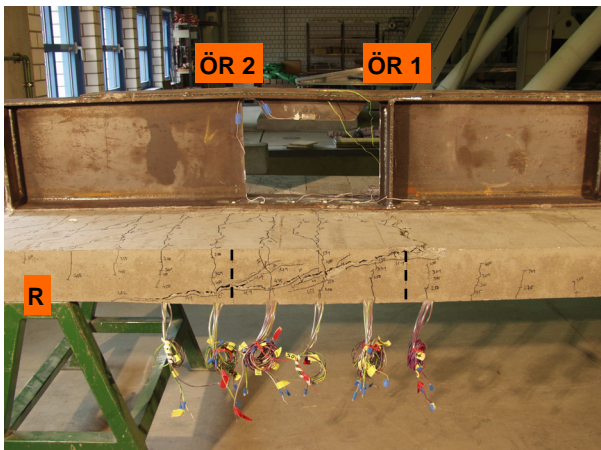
Rissbild auf der rechten Betongurtseite
